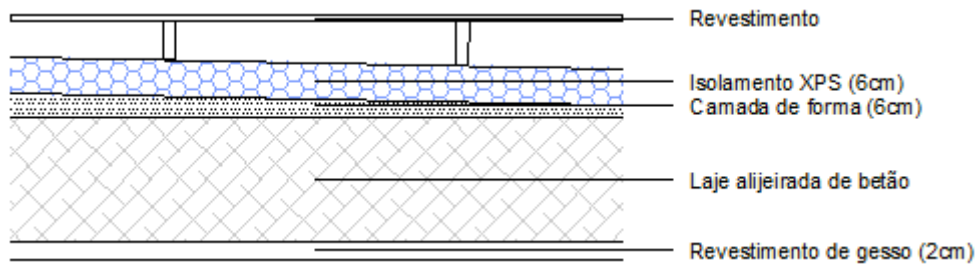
Pormenor construtivo da cobertura em contacto com o exterior
